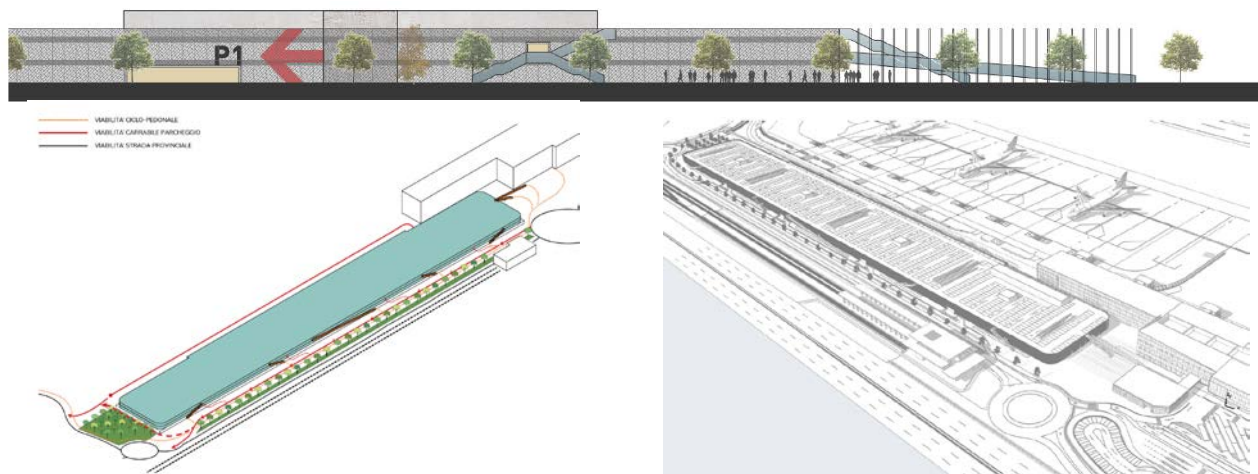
Parcheggio multipiano ovest: sezioni e rendering
